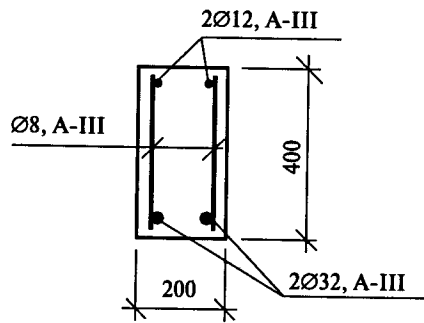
Армирование сечения балки — к примеру 7.9
